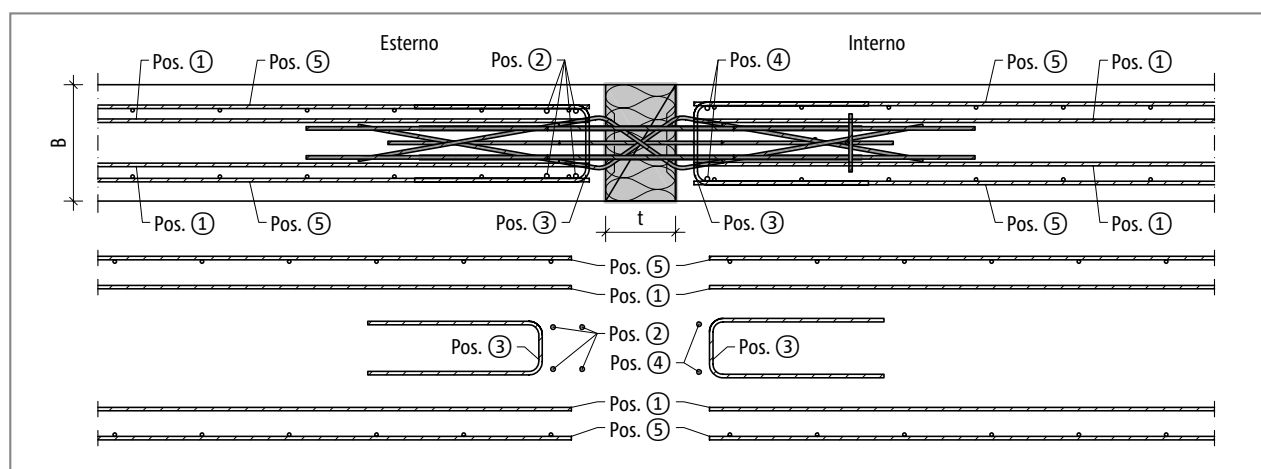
Schöck Isokorb® tipo WXT: armatura in opera; pianta
